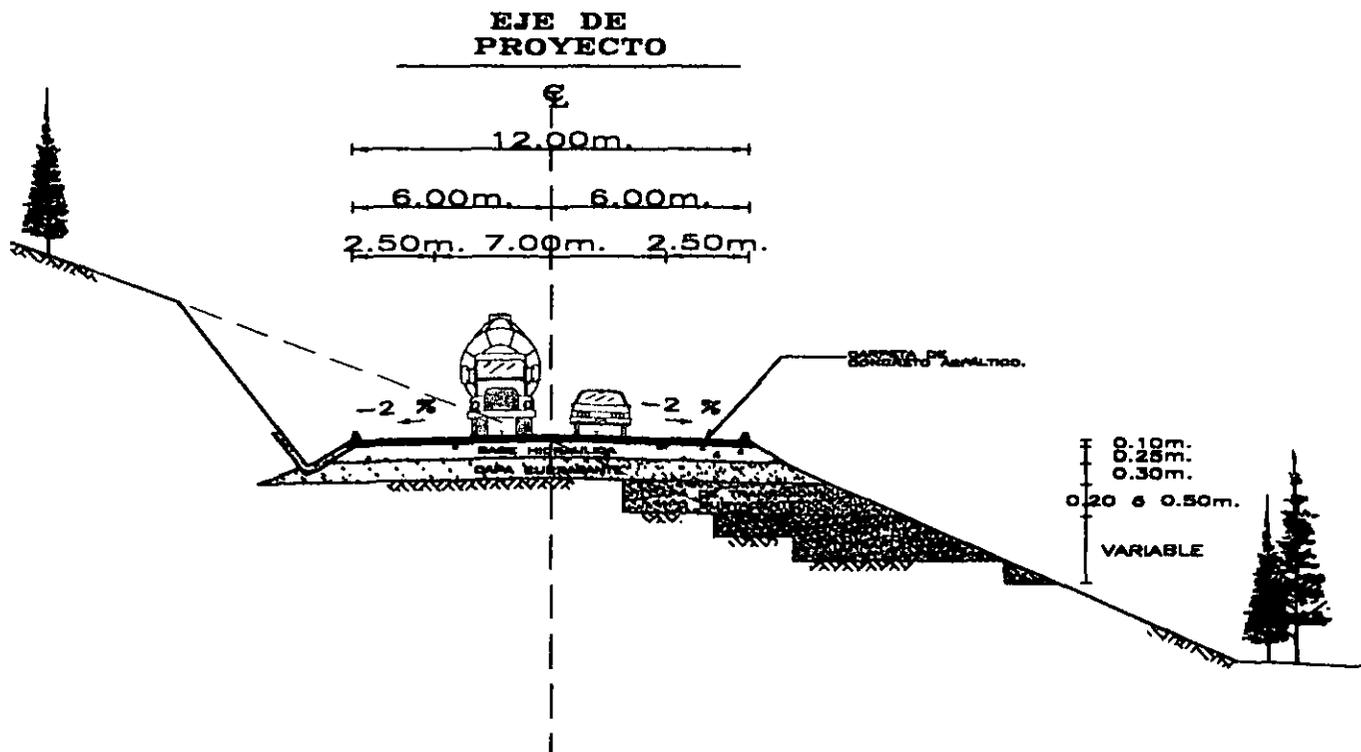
SECCION TIPO ESTRUCTURAL EN TERRAPLEN.
